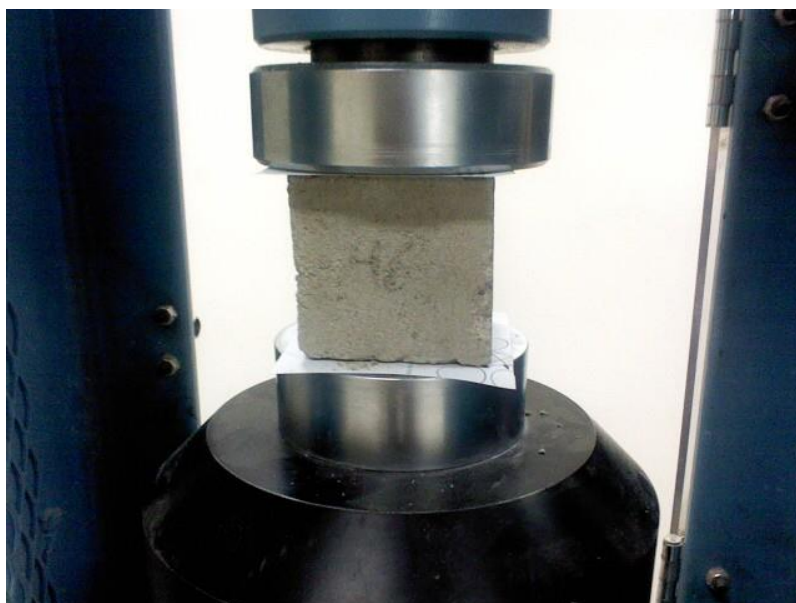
Detalle de colocación de probeta en la prensa hidráulica
